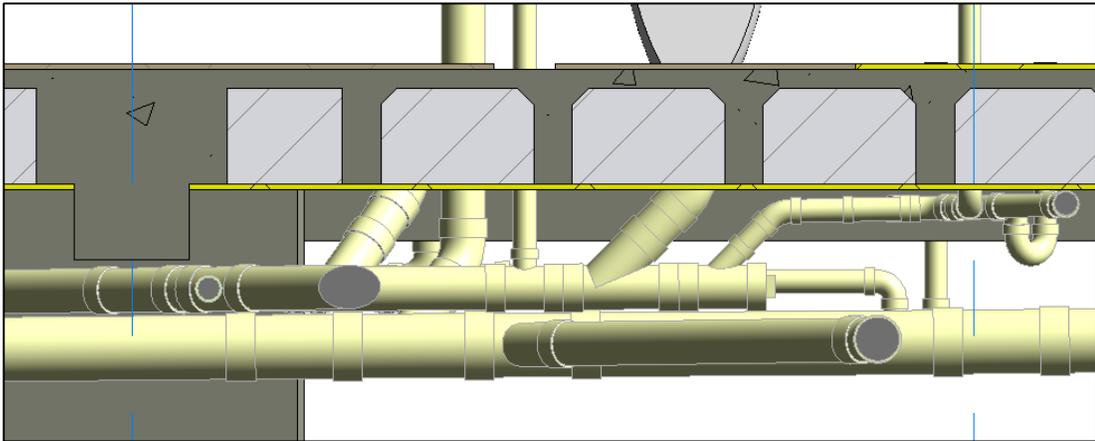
Alzado de tuberías que cuelgan de la losa de PB.
